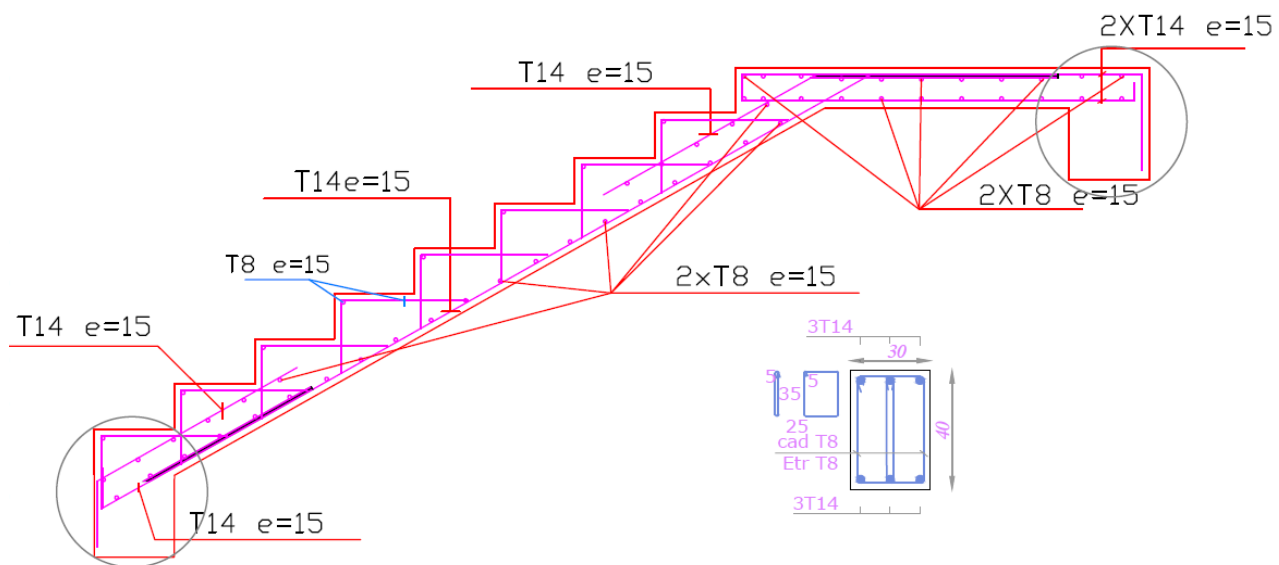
Schéma de ferrailage de la poutre palière et l'escalier
